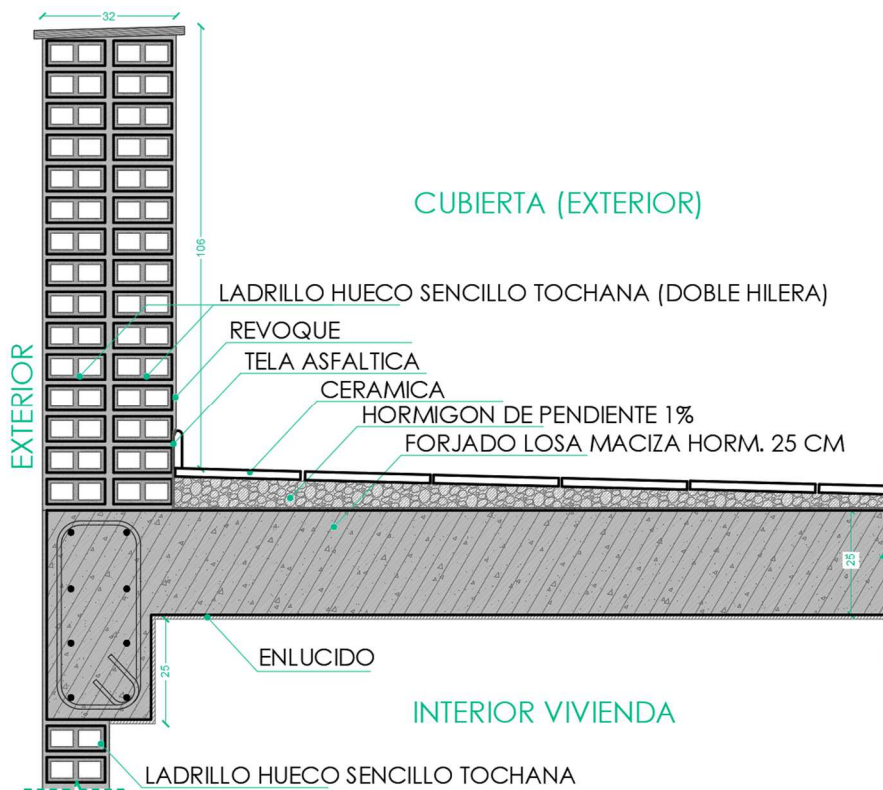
Detalle constructivo de cubierta. Elaboración propia
